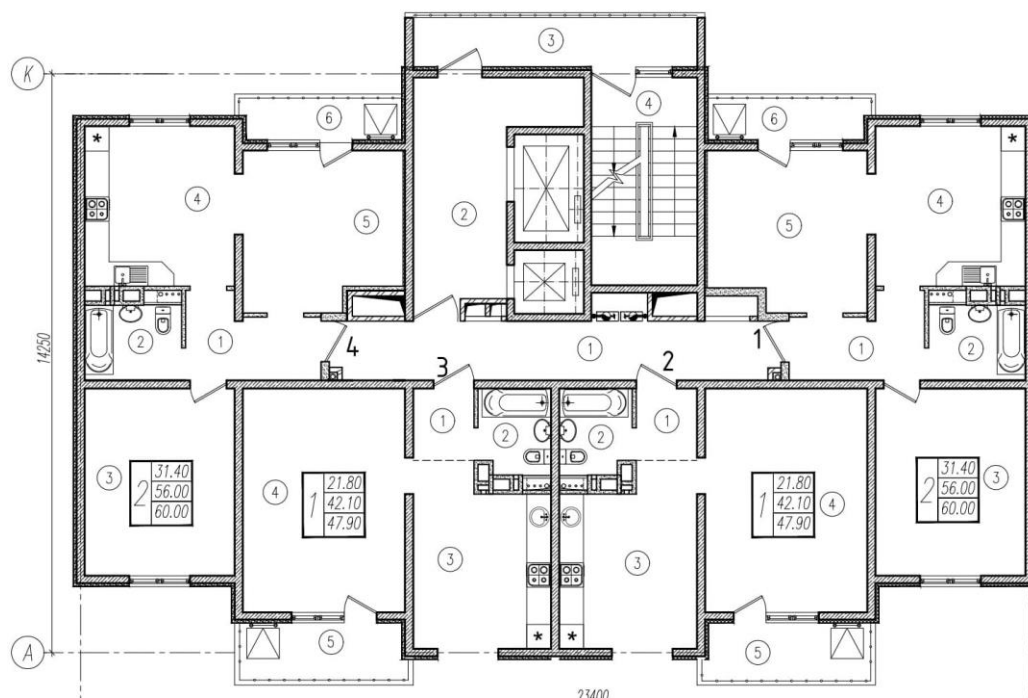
План 2-5-ого этажей 5 литеры ЖК «Горный квартал»
